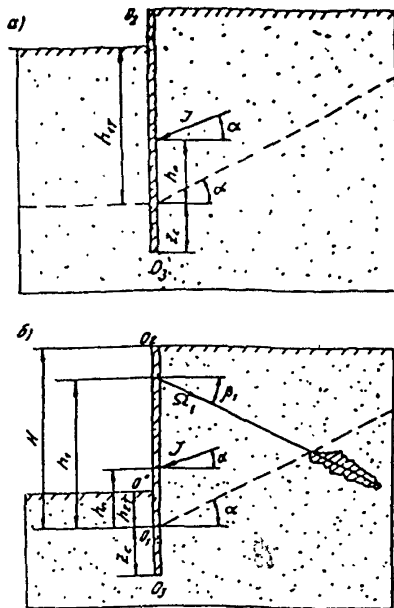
Схема к расчету допустимой глубины отрыва котлована под анкерное крепление: а - первый ярус; б - второй ярус
